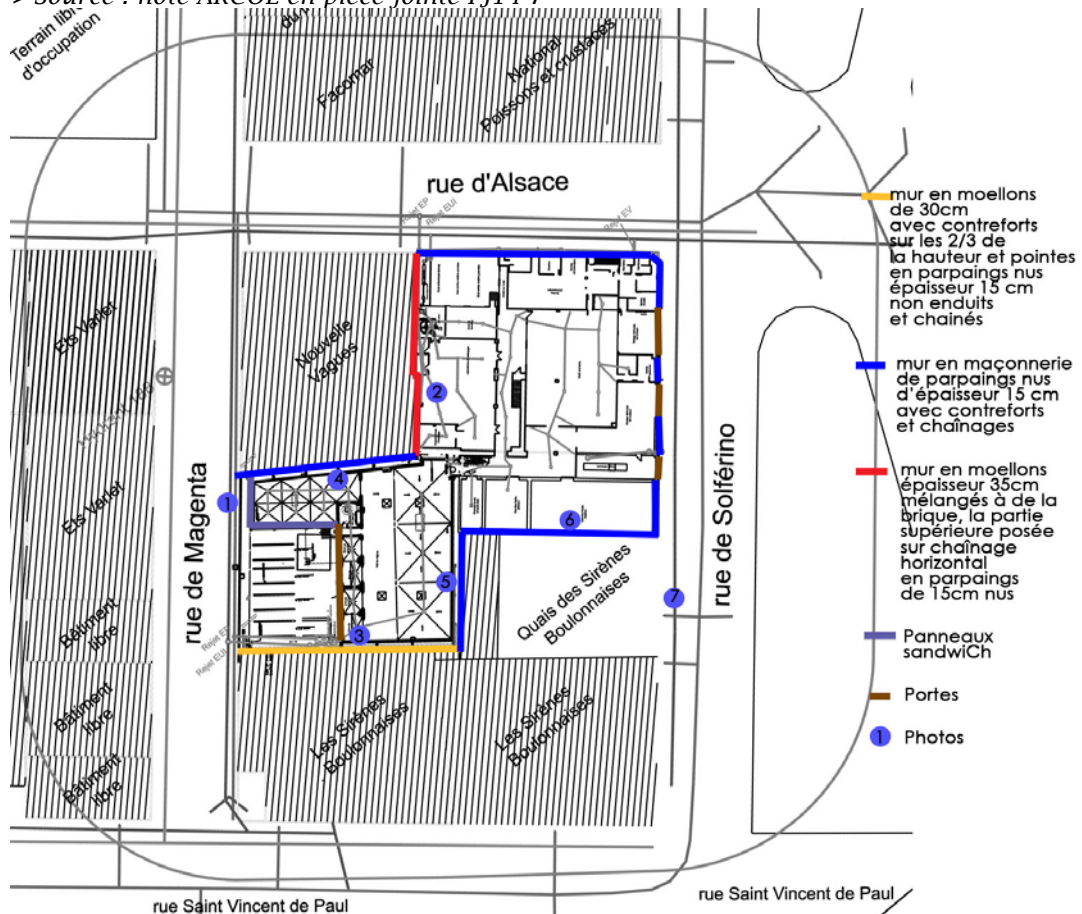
Parois périphériques autour de l'emprise DEMARNE
